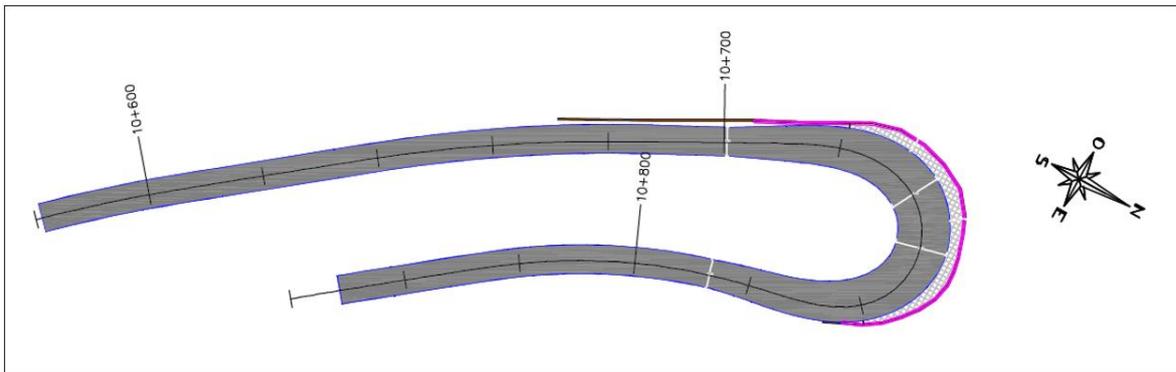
Planta del murete entre el PK 10+670 y el PK 10+770.
